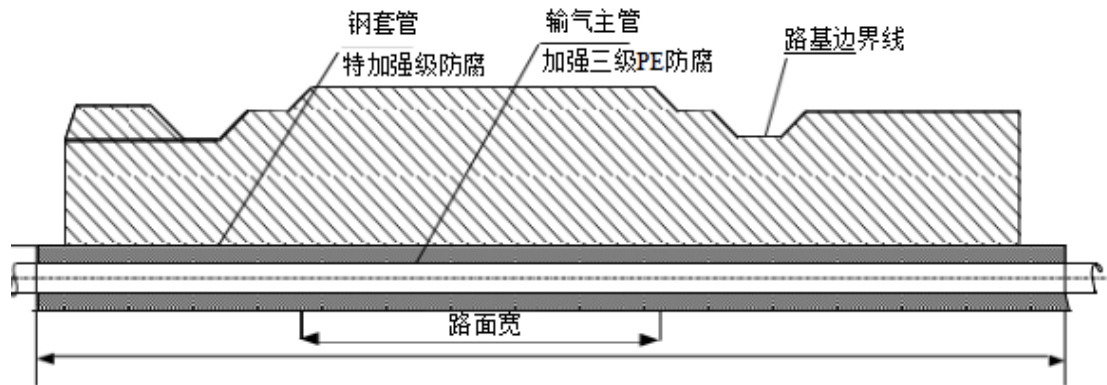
乡村水泥道路、机耕道穿越施工方式断面示意图
